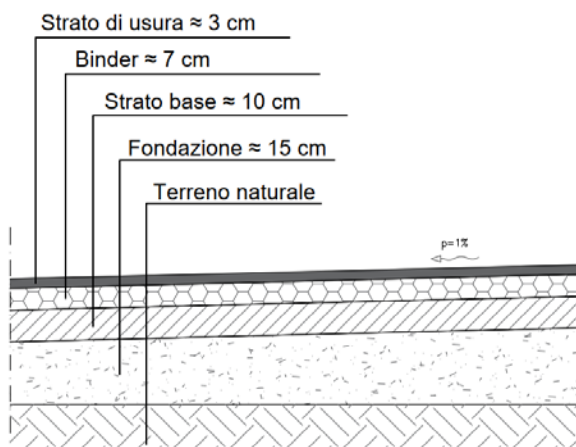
Tipologico pavimentazione impianto – stralcio Tavola “Allegato 10_Viabilità”
